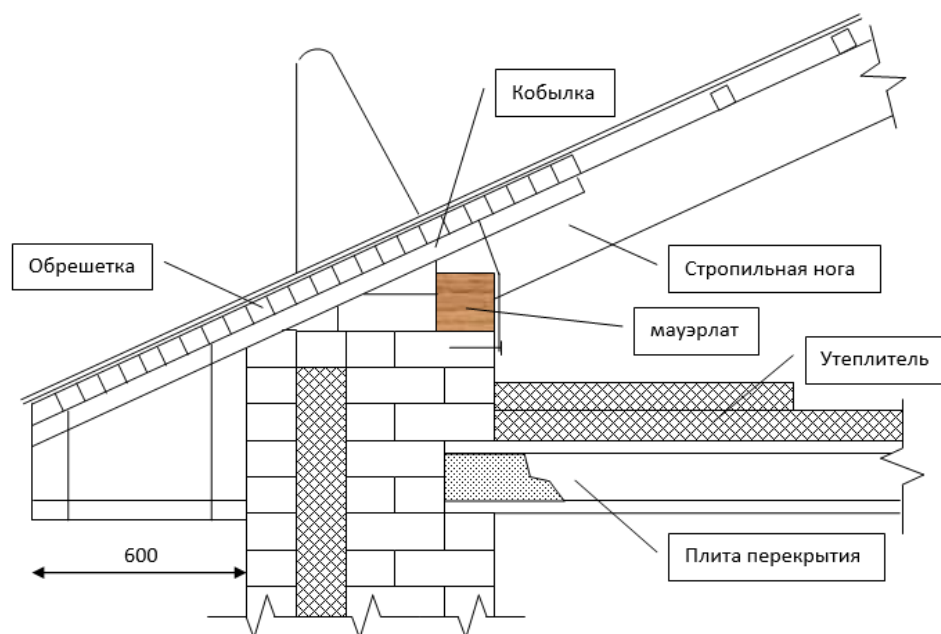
Узел опирания стропильной ноги на несущую кирпичную стену
